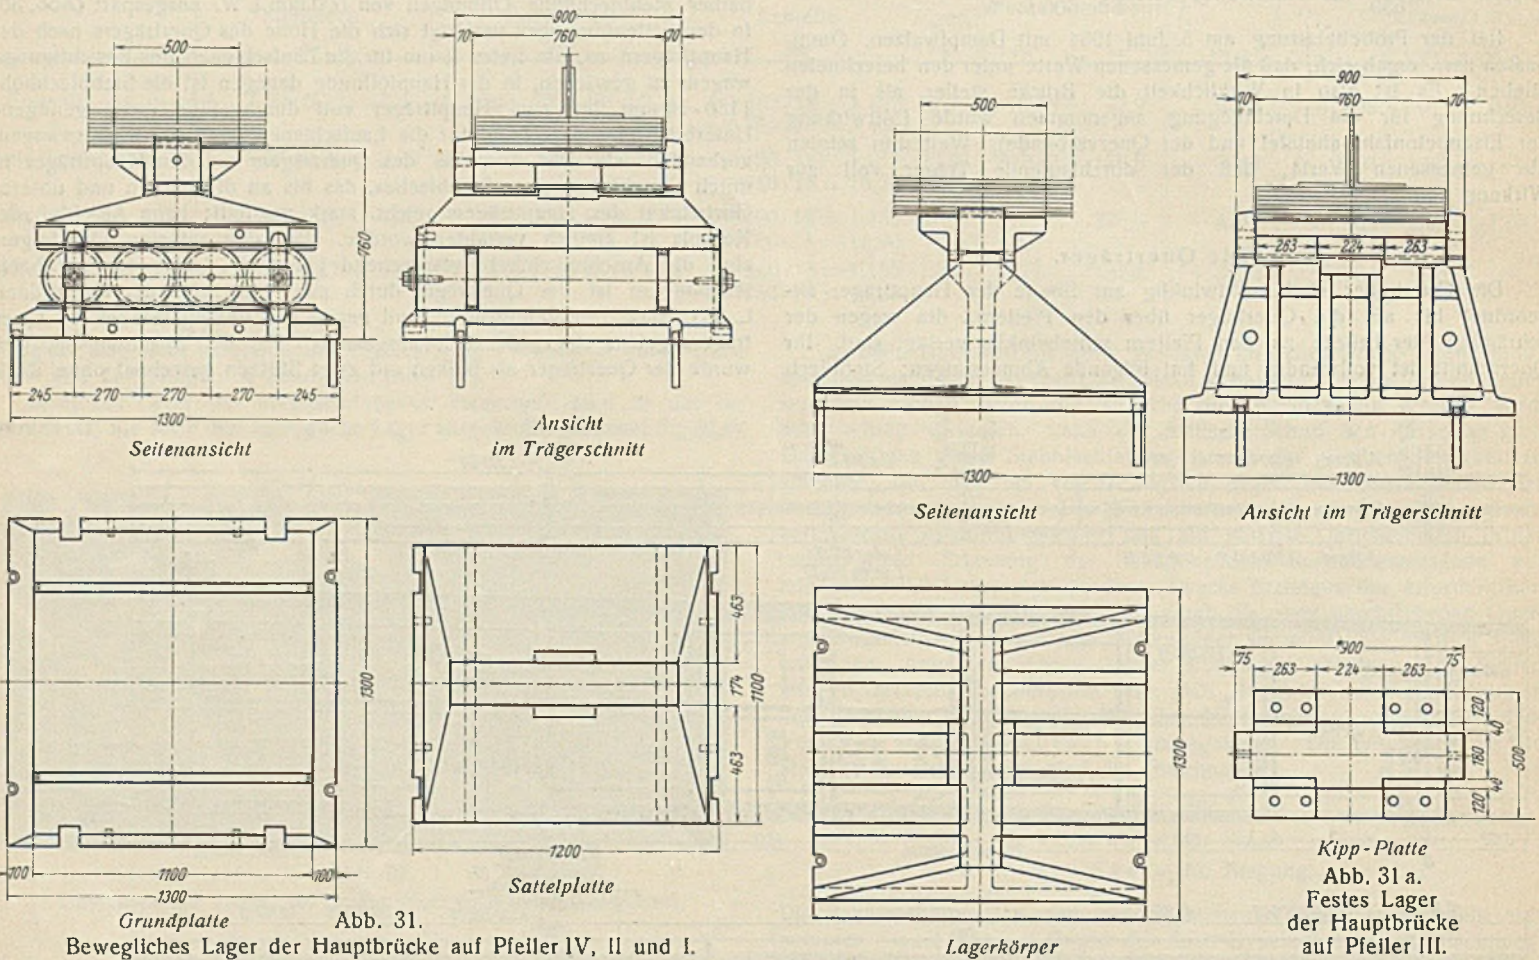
Bewegliches Lager der Hauptbrücke auf Pfeiler IV, II und I.
